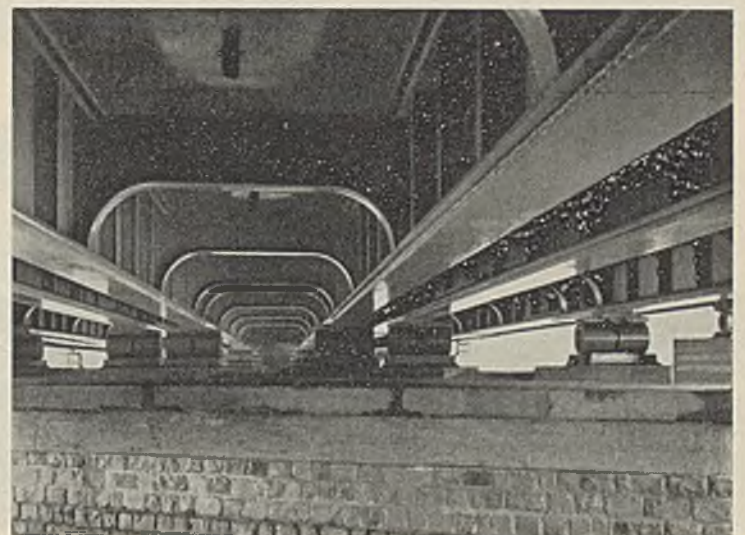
Siegbrücke bei Eiserfeld. Unteransicht.
